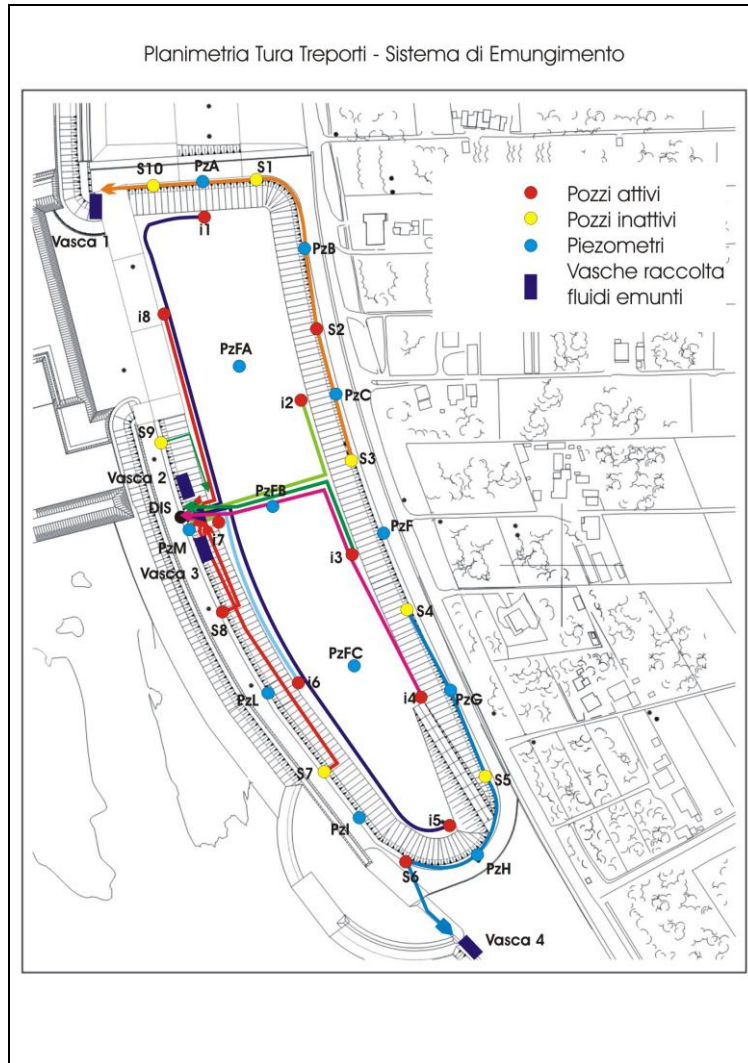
Planimetria del sistema di dewatering della tura (fonte: Consorzio Venezia Nuova).
